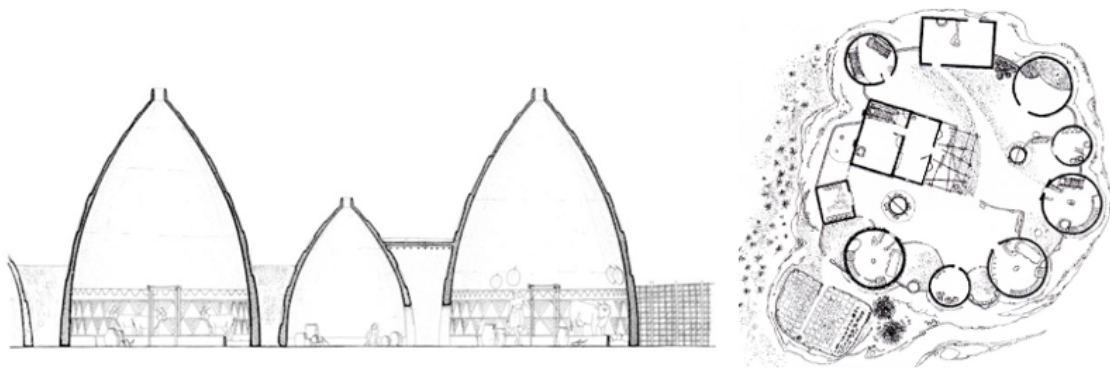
Corte e Planta Tipo Casas Musgum - Camarões
